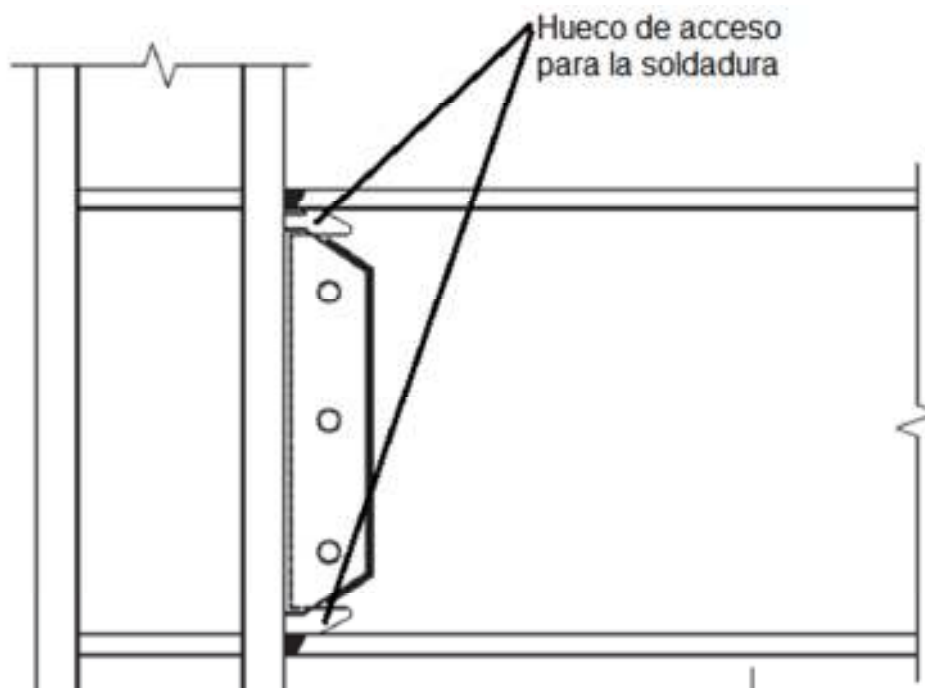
Huecos de acceso para soldadura entre el alma y patines de la viga.
